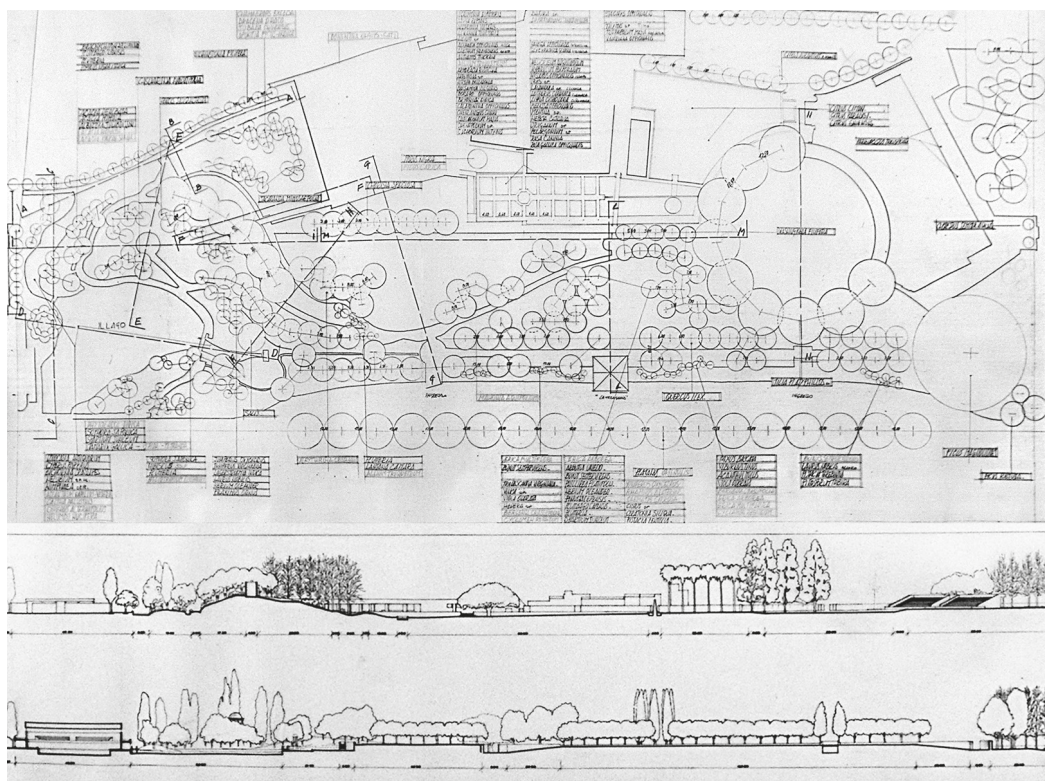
Verde Sperone. Planimetria dell'impianto vegetativo e sezioni longitudinali.
